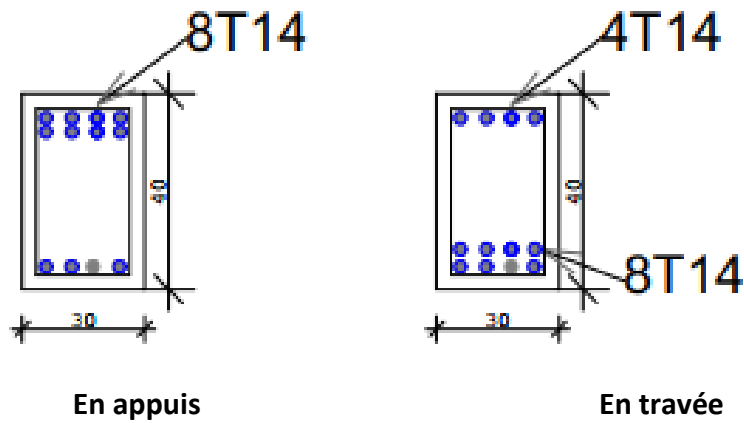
Ferrailage de la poutre principale (30x40).
